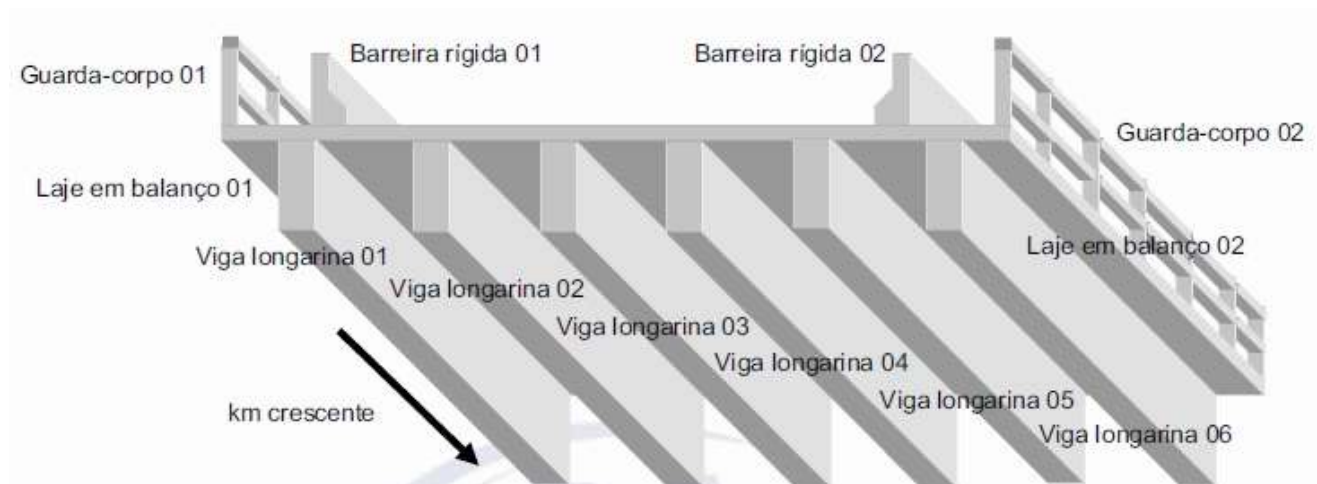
Croqui indicativo Nomenclatura dos elementos estruturais.
